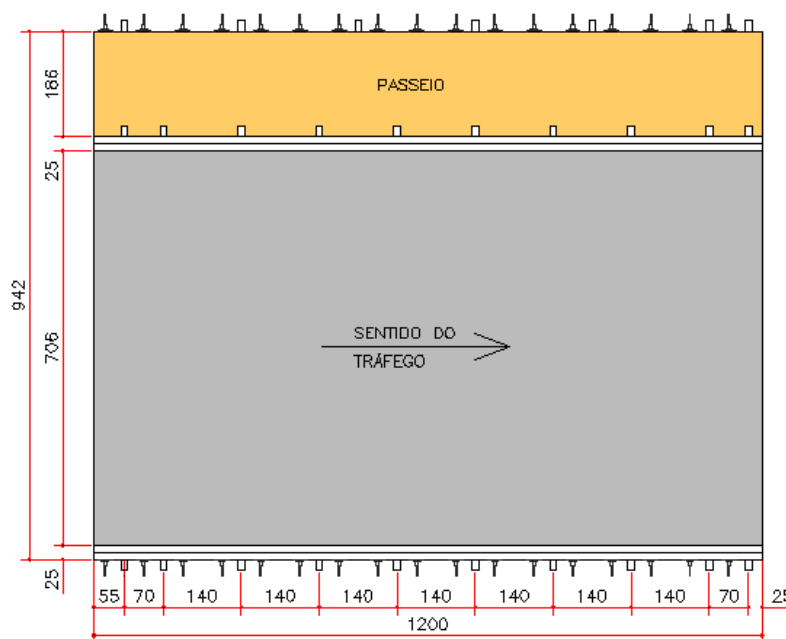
Planta baixa da ponte do Campus II da USP São Carlos
